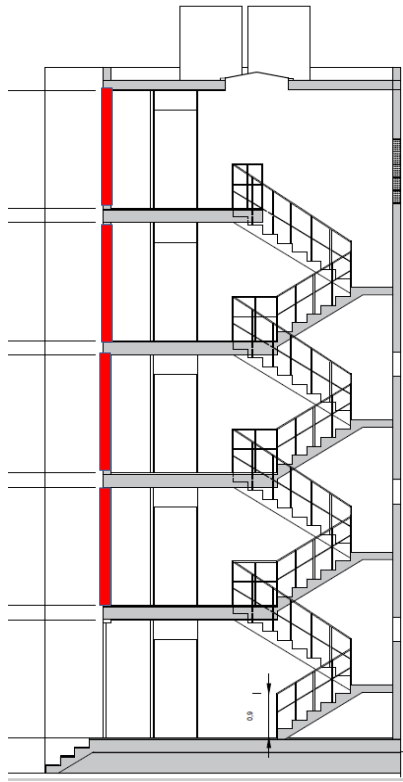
Detalle Sección Transversal ubicación muros a demoler para Ascensor.
